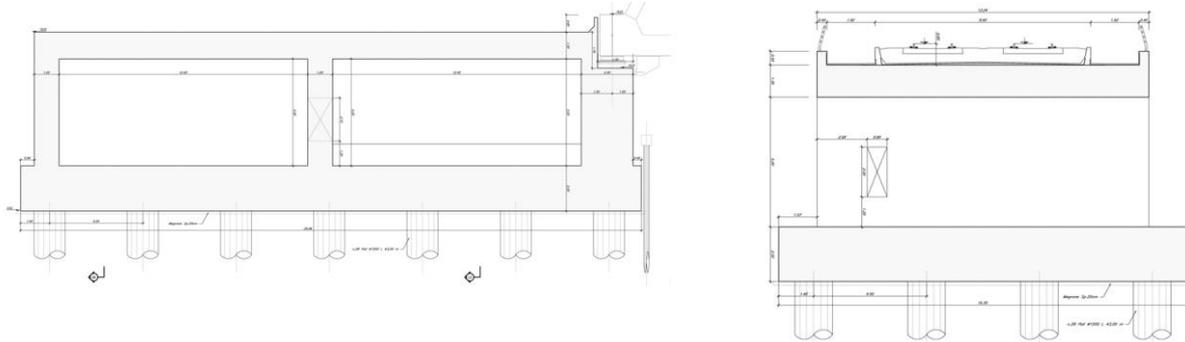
Sezione longitudinale spalla (sinistra) e Sezione trasversale della spalla (destra)
